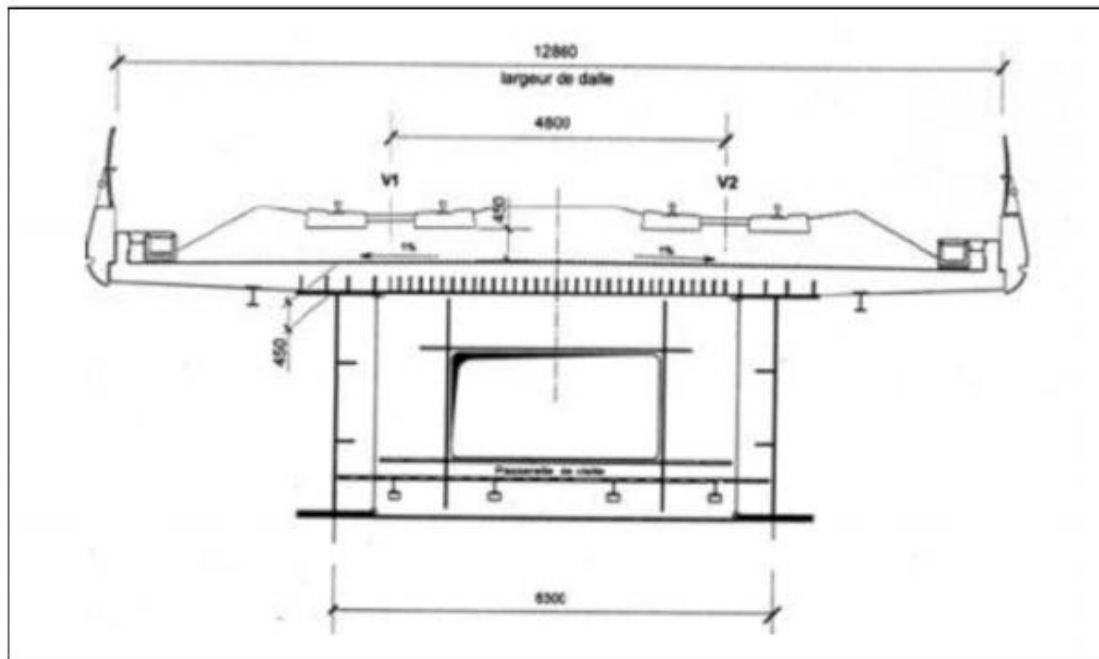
Coupe transversale bipoutre ferroviaire à diaphragme
